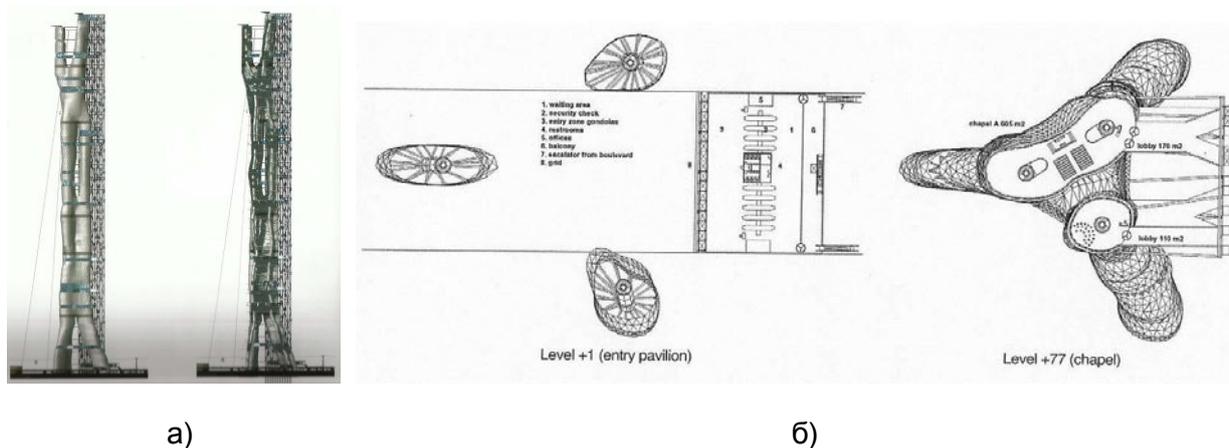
Rotterdam City Tower, «MONOLAB Architects», 450 м: а) фасад, разрез; б) планы этажей [8]
